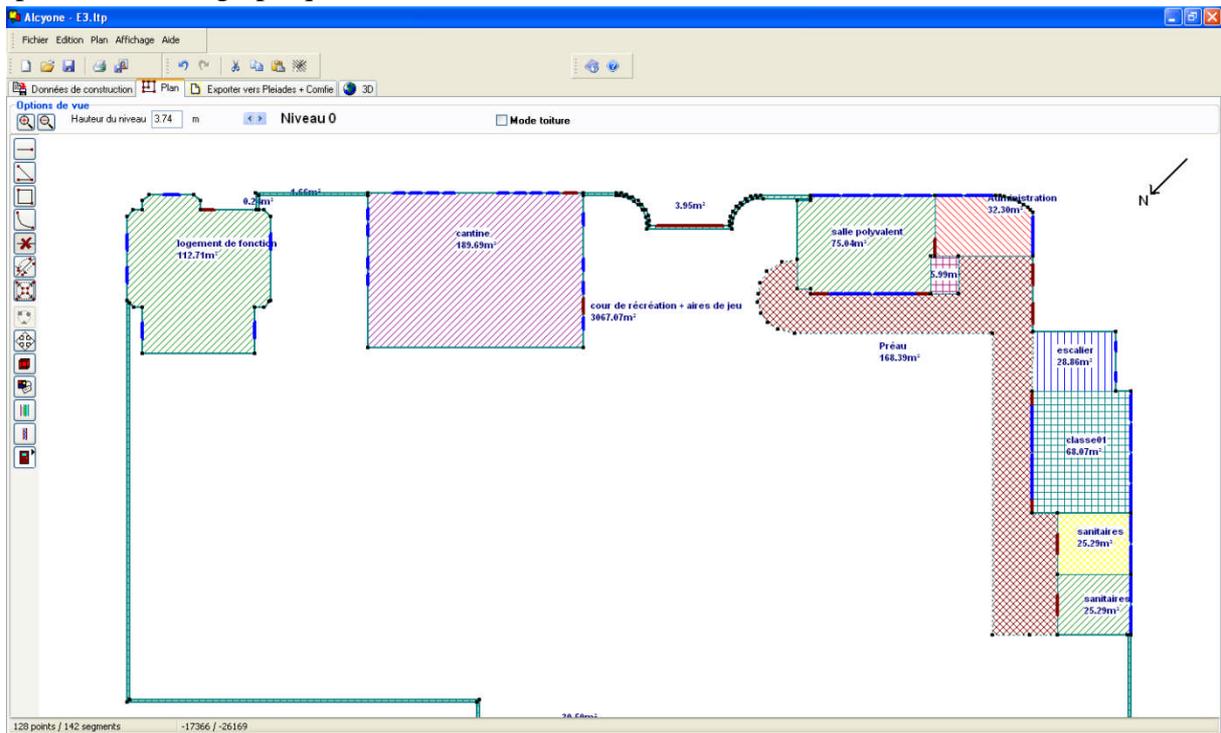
Plan du rez-de-chaussée de E2-A1-MM
